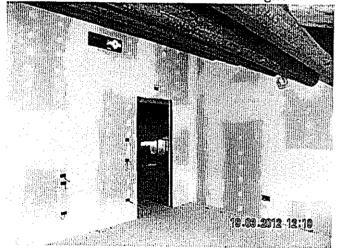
Stanza 2.4: Vista parete interna con porta ingresso
